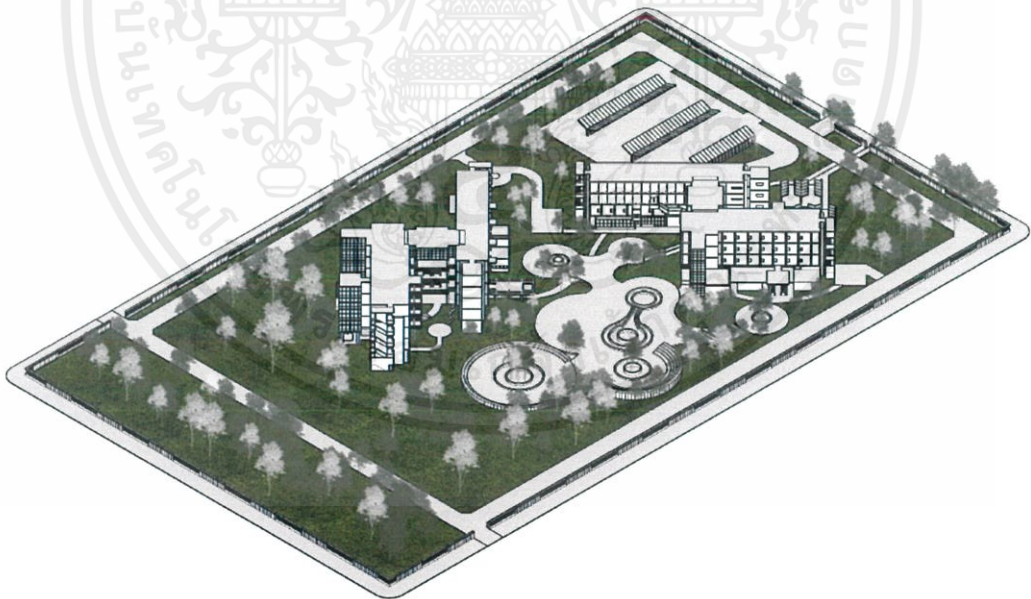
7 B BUILDING CLASSROOM (3rd, 4th, 5th) FLOOR ISOMETRIC
